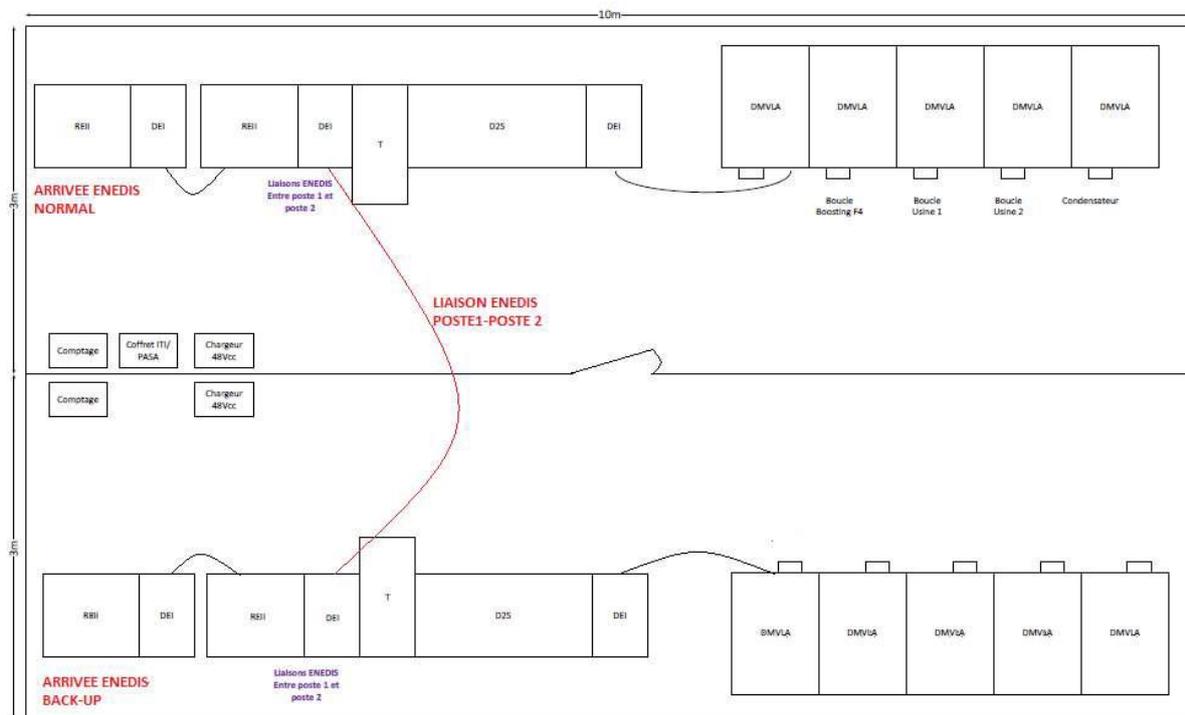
Plan RDC prévisionnel du nouveau poste HT
